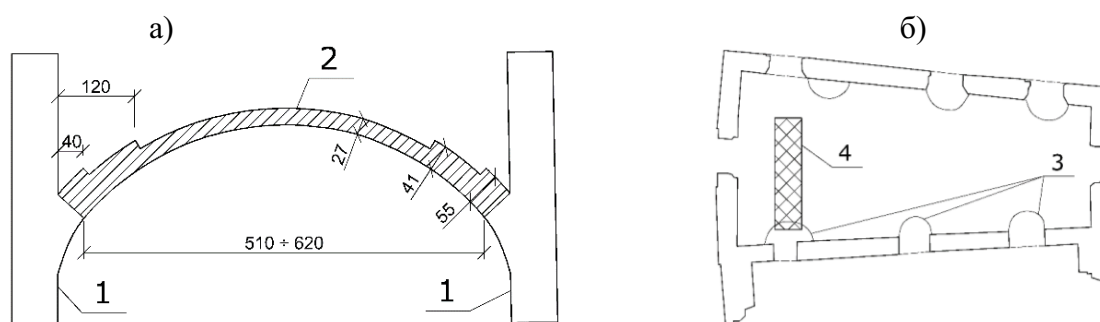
Поперечный разрез (а) и план (б) цилиндрического каменного свода междуэтажного перекрытия с проемом для инженерных сетей:
